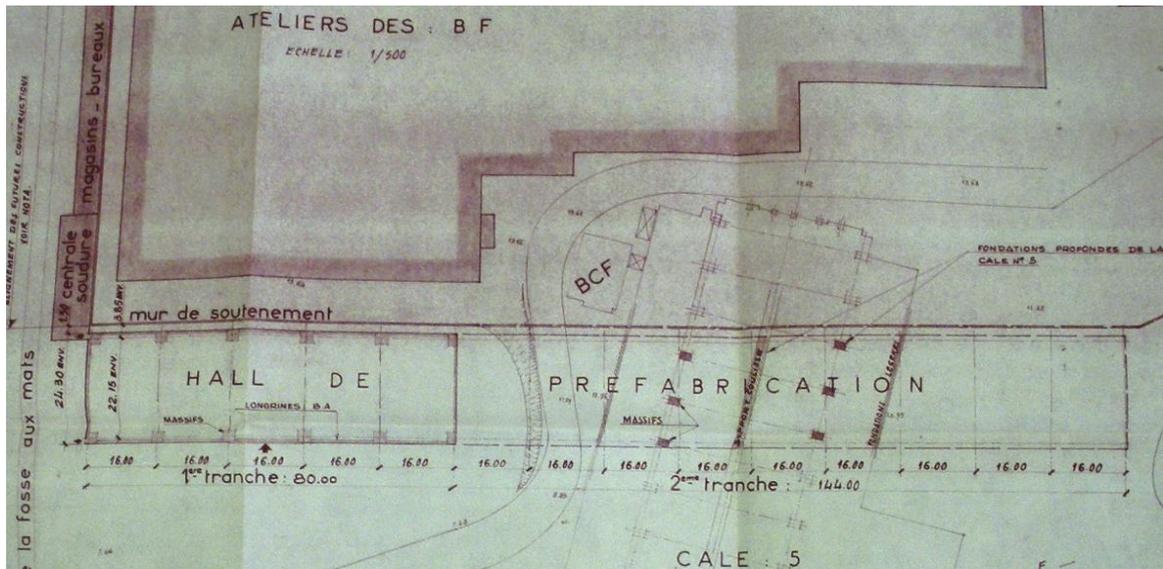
Avant-projet de construction d'un hall de préfabrication
